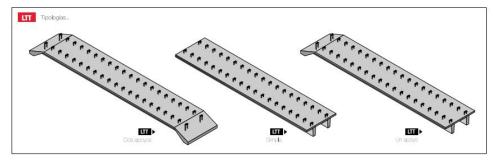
Dimensiones mínimas y máximas de losetas nervadas con apoyo doble, único y sin apoyos (simples). Fuente: Catálogo Tensocret.
